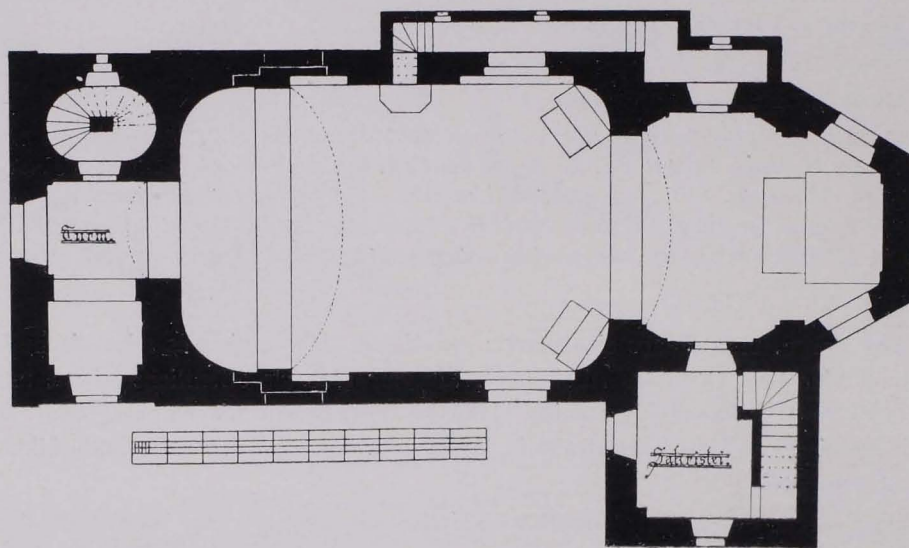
Grossau, Pfarrkirche, Grundriß 1 : 200 (S. 61)
